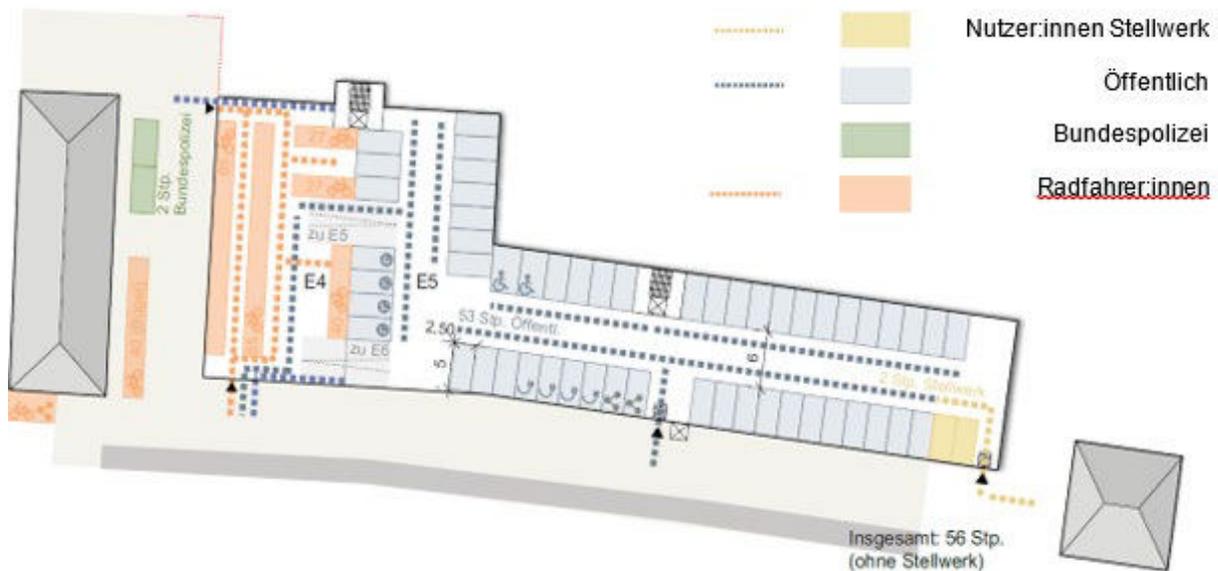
Funktionsgrundriss Parkhaus Ebene E4-E5 (o.M.)
